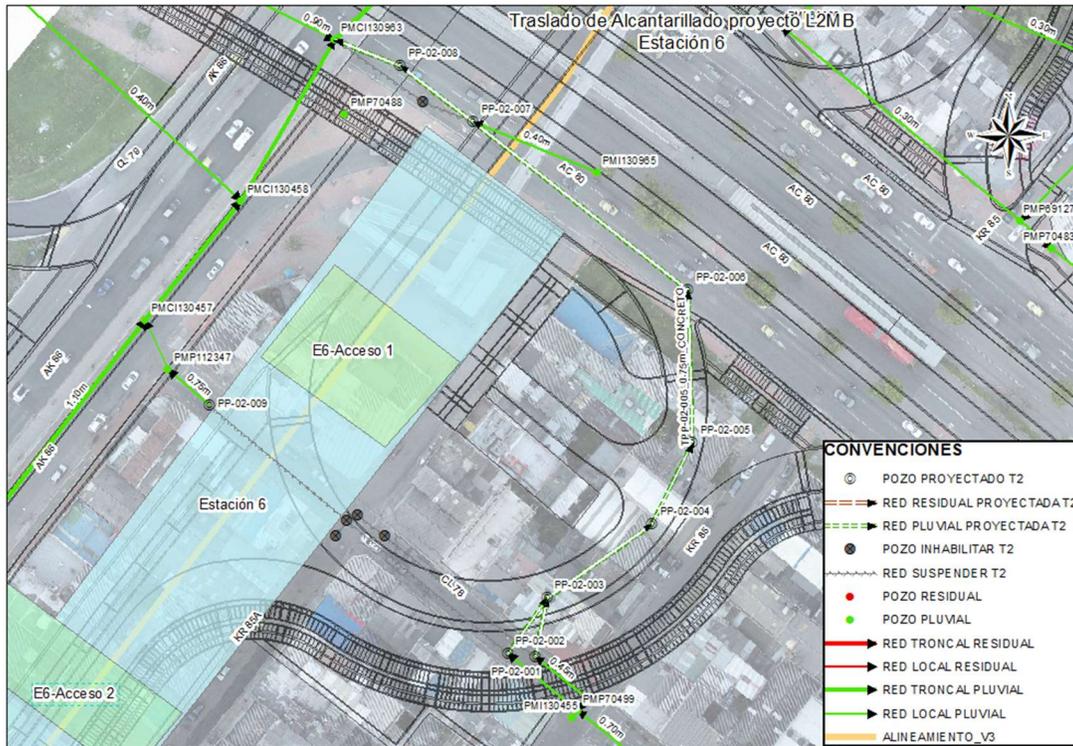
Traslado redes de alcantarillado Estación 6 Carrera 85A con calle 77A Red Pluvial
